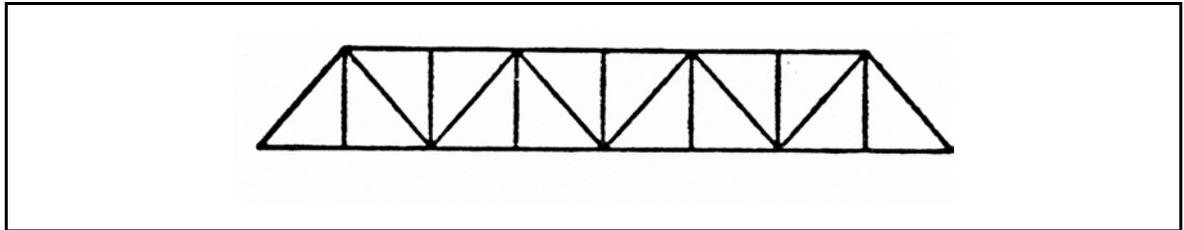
Einfaches Strebenfachwerk mit Vertikalstreben
